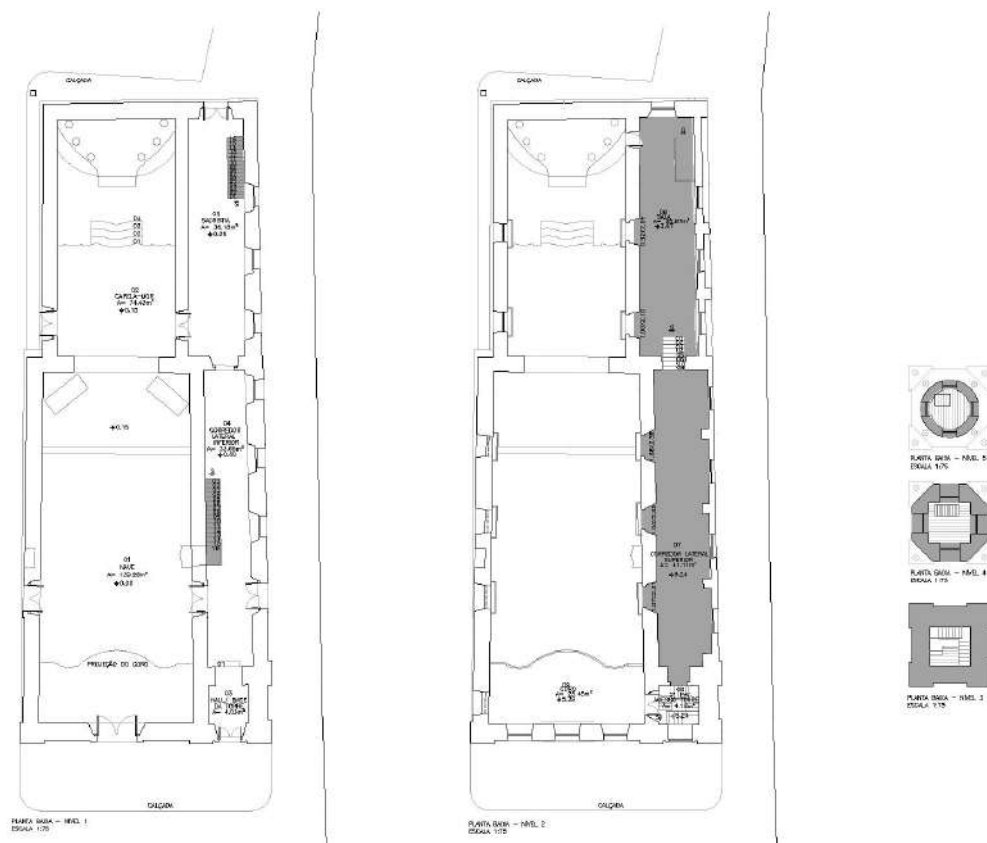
Planta da Igreja no século XVIII, onde encontra-se em destaque as melhorias feitas no século indicado.
